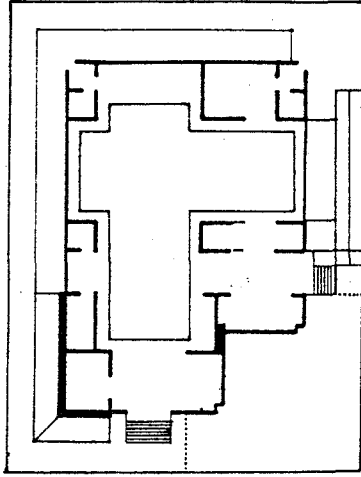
Sevilla Dünya Fuarı (1992) Türkiye Pavyonu vaziyet planı
